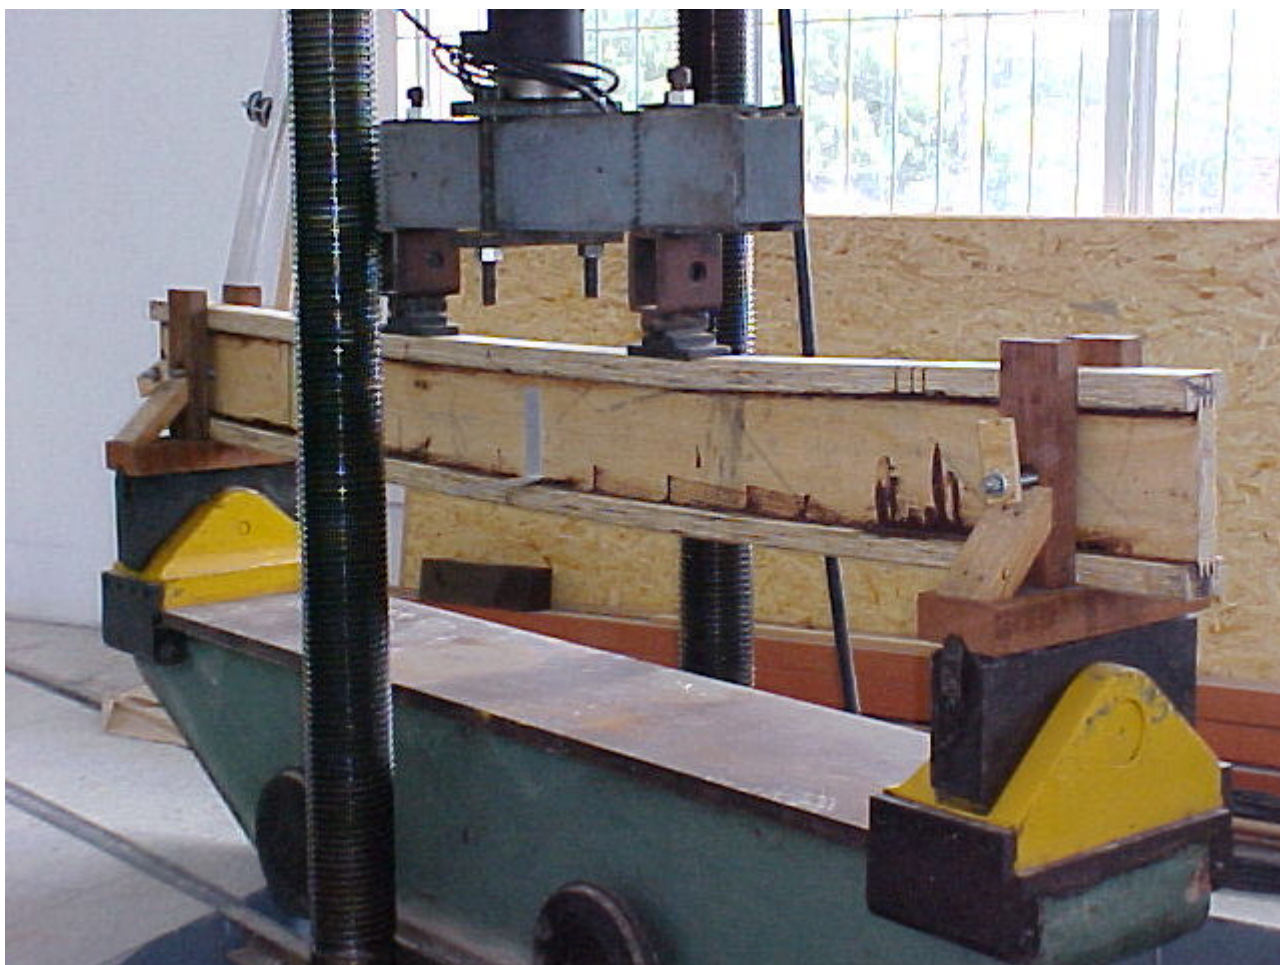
Ruptura da Viga Mesa Maciça – V2 – Flexão e Tração da Mesa inferior junto a um nó.
